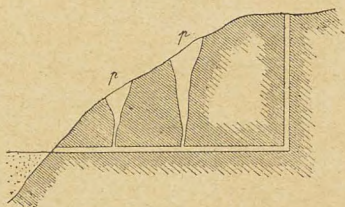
Coupe transversale du terrain suivant l'axe du tunnel et du puits.
